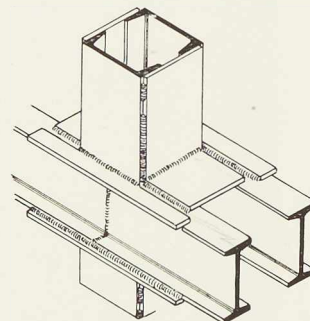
Appui d'une poutre double sur un poteau en caisson.
